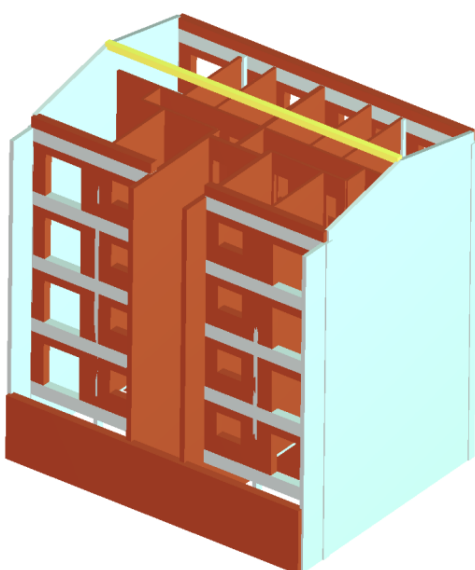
Estrutura em betão e paredes em alvenaria
